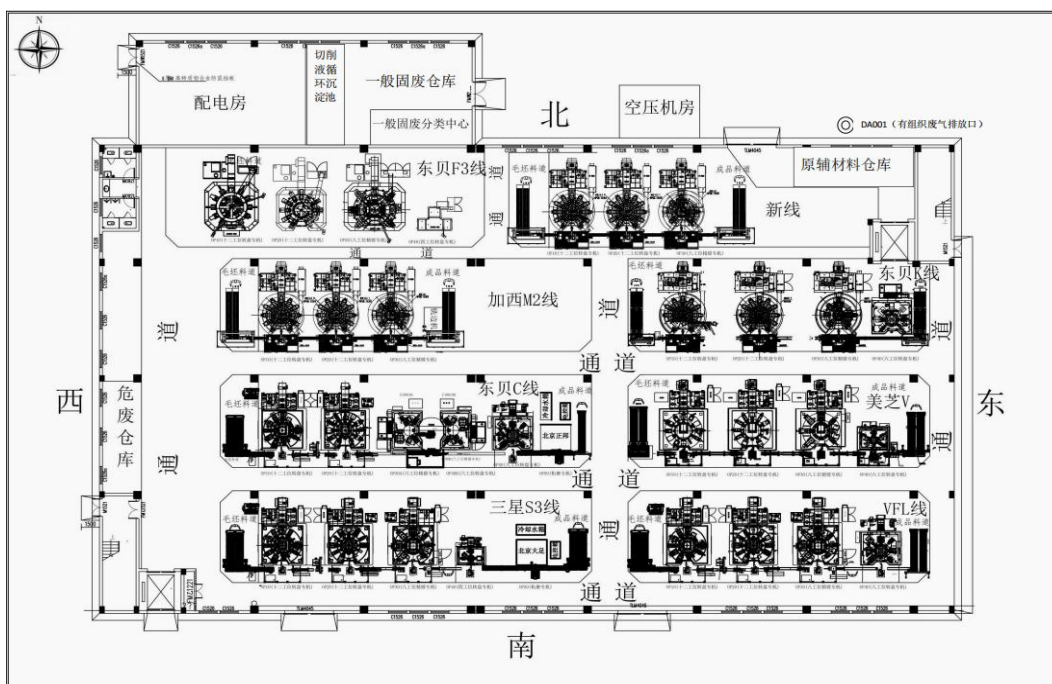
建设项目环评审批 1#厂房一楼平面布置图
